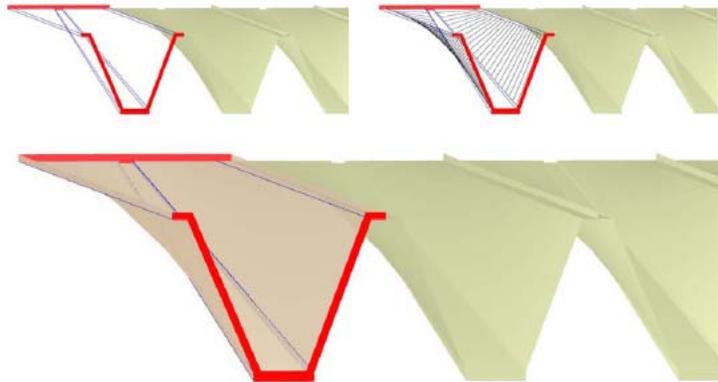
Plantas y alzado del voladizo del estadio Flaminio, Roma. <sup>217</sup>
